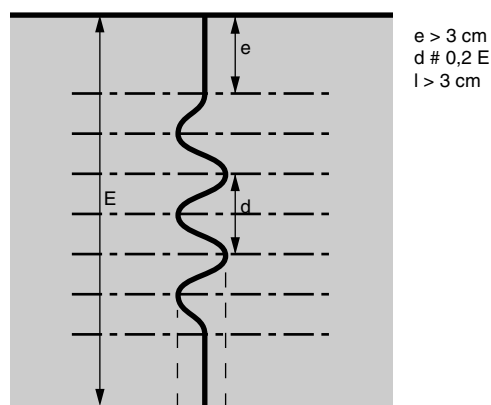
profil vertical d'un joint longitudinal entre deux bandes de béton
